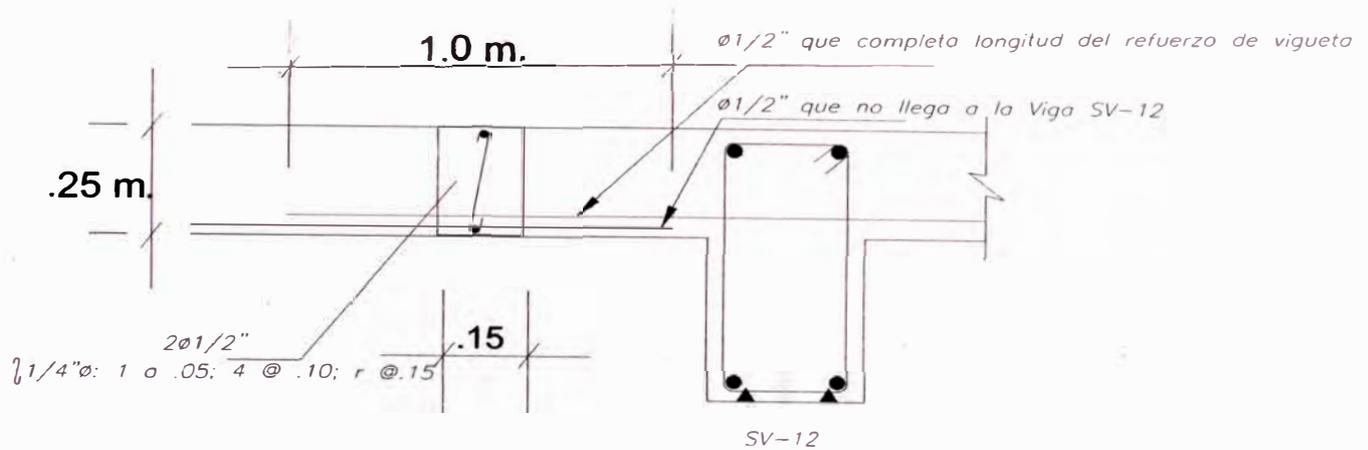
Detalle de nueva viga (perpendicular a las viguetas) en losa de sótano debido a falta de longitud en refuerzo de vigueta -ésta no llega hasta la viga SV-12-. Ver E-04, Losa de sótano.
